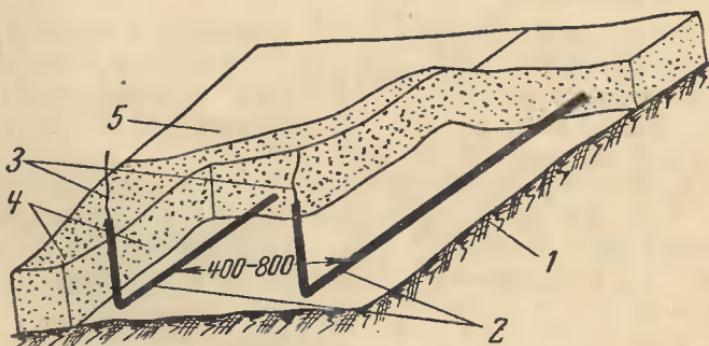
Укладка горизонтальных электродов на мерзлый грунт с засыпкой опилками.
